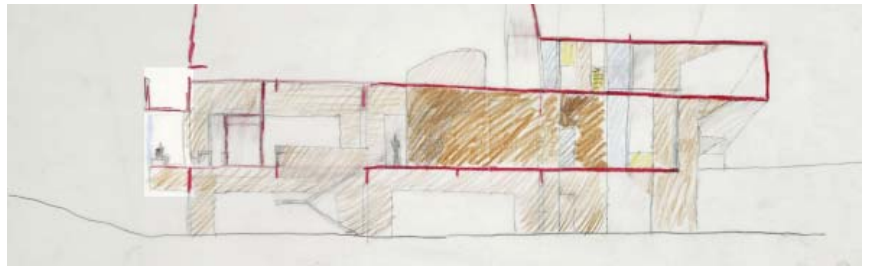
Dibujo en sección con detalle del canalón de la segunda versión. Fuente: FLC. 16598
